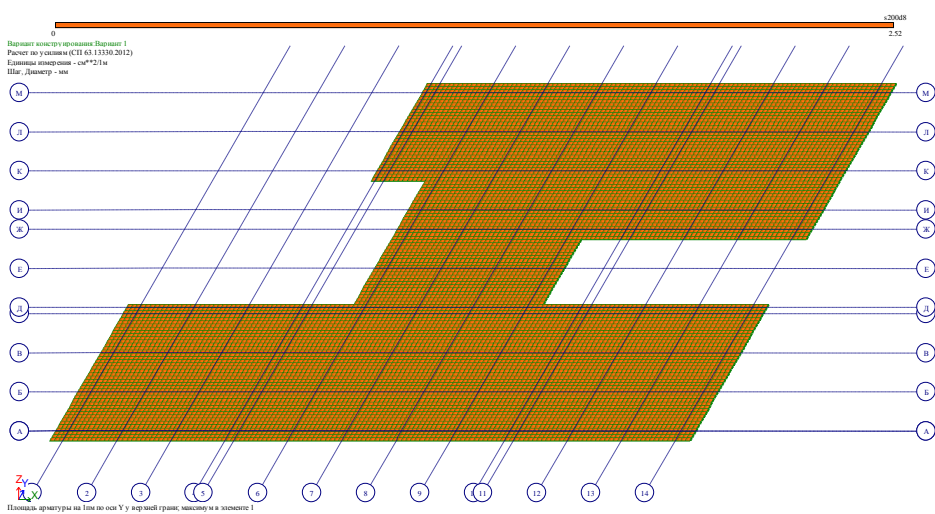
Площадь арматуры по оси Y у верхней грани
